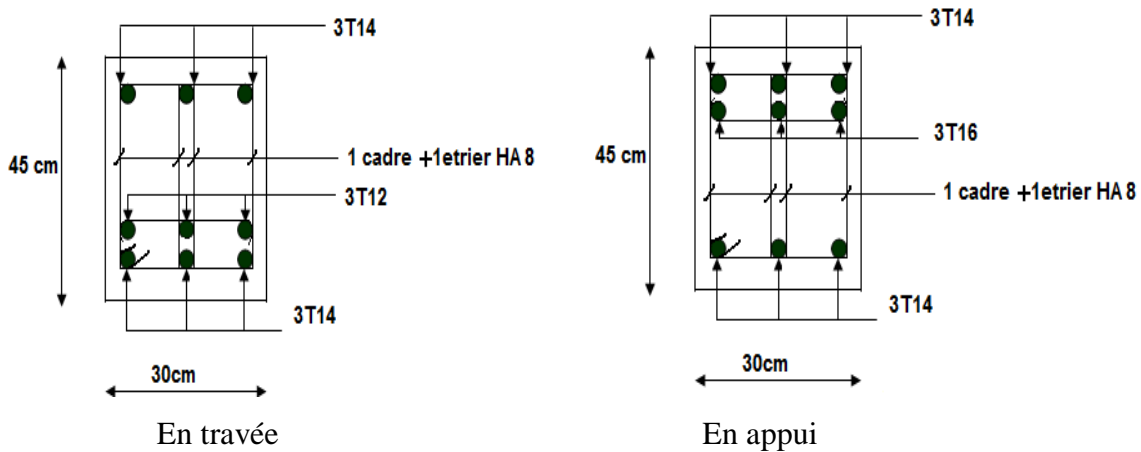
Ferrailage des poutres principales (30x50) de niveau 6,12 m
